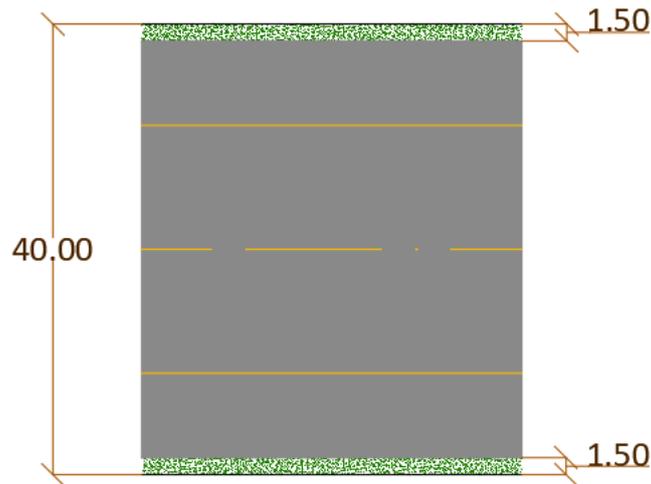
Recorte acotado de la franja de una de las calles de rodaje [Elaboración propia en AutoCAD]
